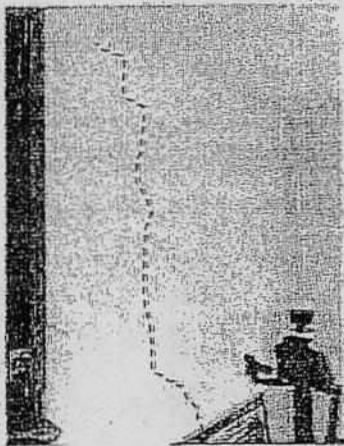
y 58. Fisura en muros interiores y perimetrales apartamento 304 torre costado norte.
